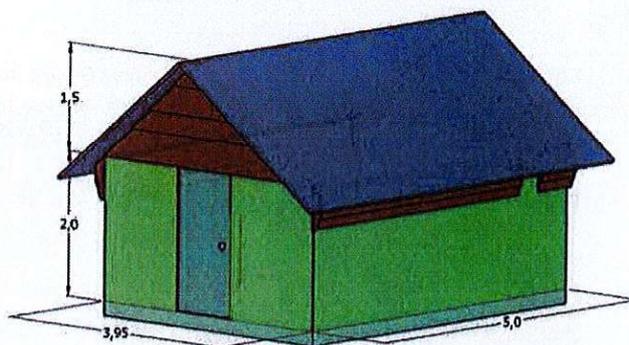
Exemple de schéma de principe d'un gîte à chiroptère partie aérienne (Source : LPO) ; N.B. : la chambre souterraine ou semi enterrée n'est pas visible)
